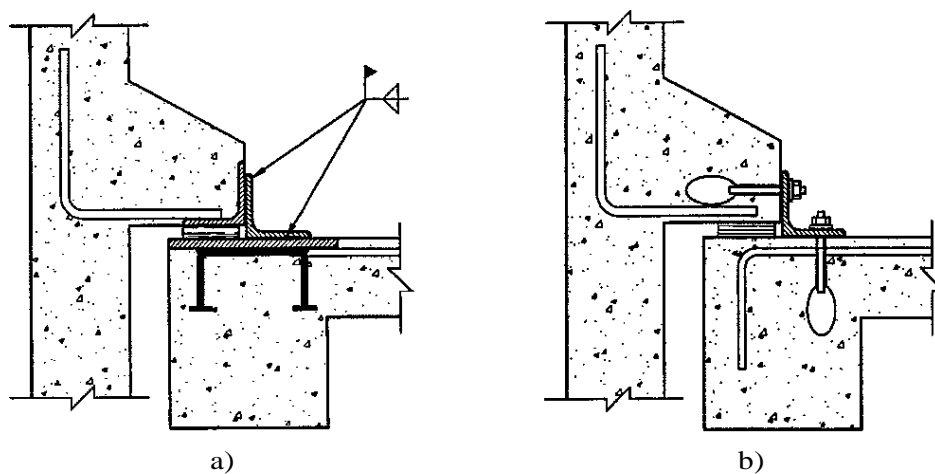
Ligação painel de fachada - viga: a) com soldadura, b) com aparafusamento [30]
